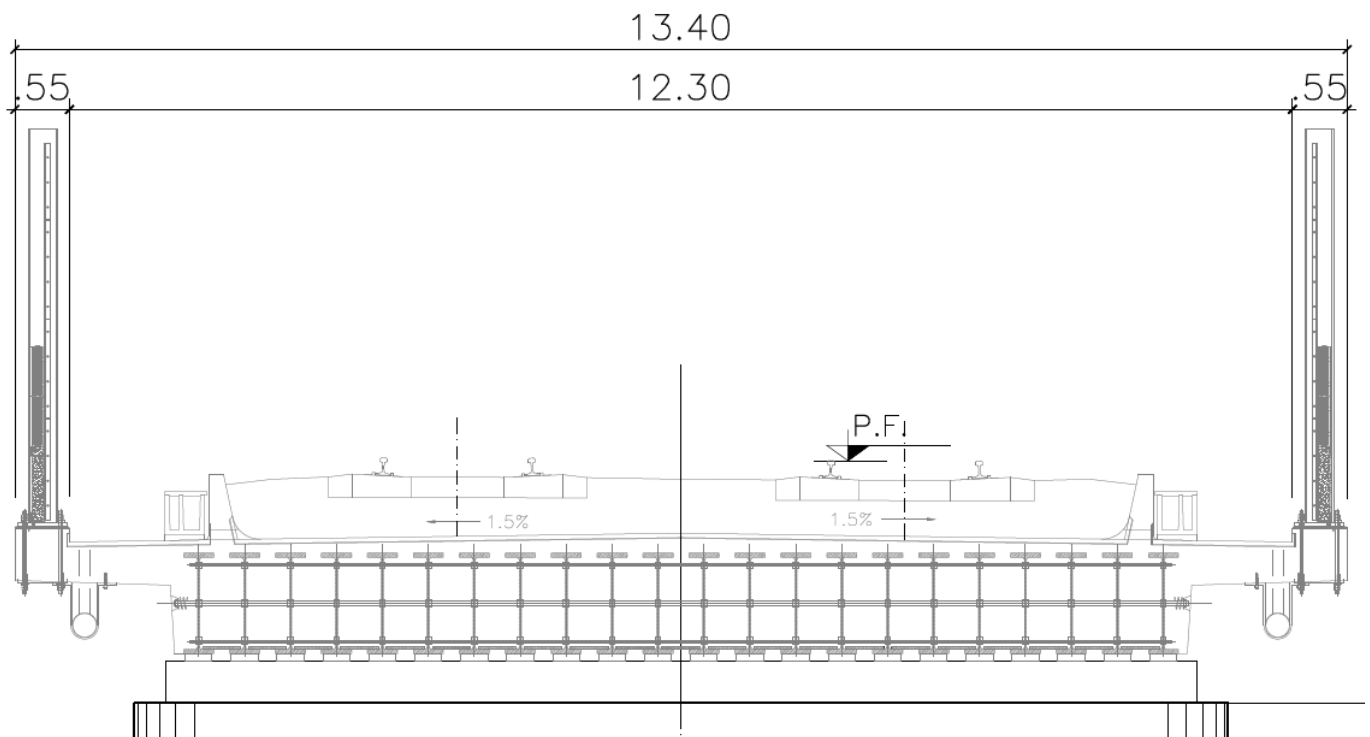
Sezione tipo - trasversale impalcato da 22,0m con travi incorporate.
